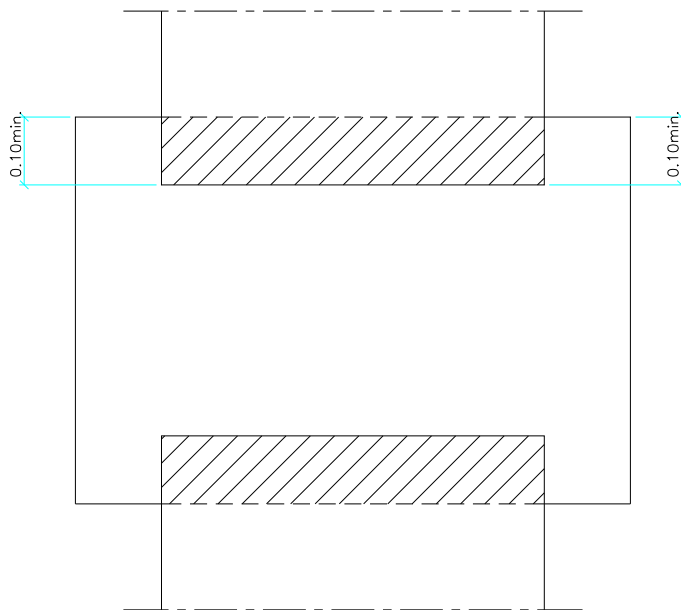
Joint plat sur terrasse accessible aux piétons, raccordement sur une étanchéité bicouche bitume modifié
